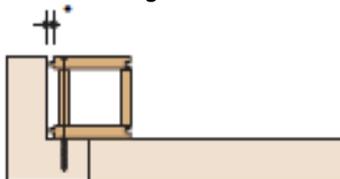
Sistema Lignatur Box Element, armado ¹⁰
